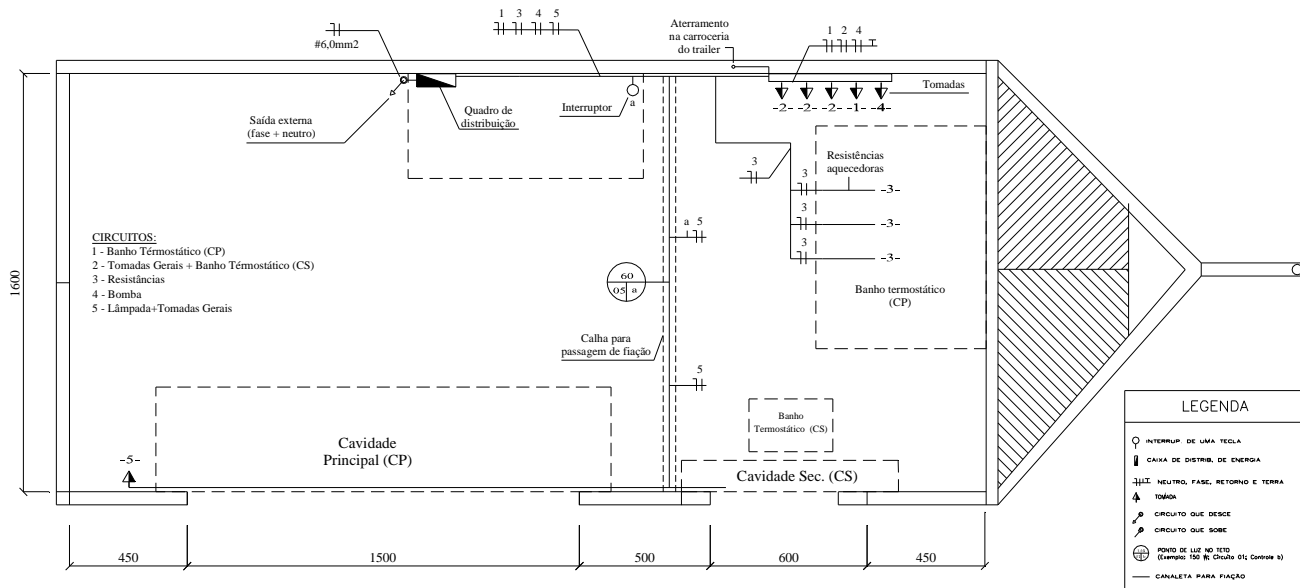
Projeto elétrico do calorímetro (vista em planta, sem escala)
